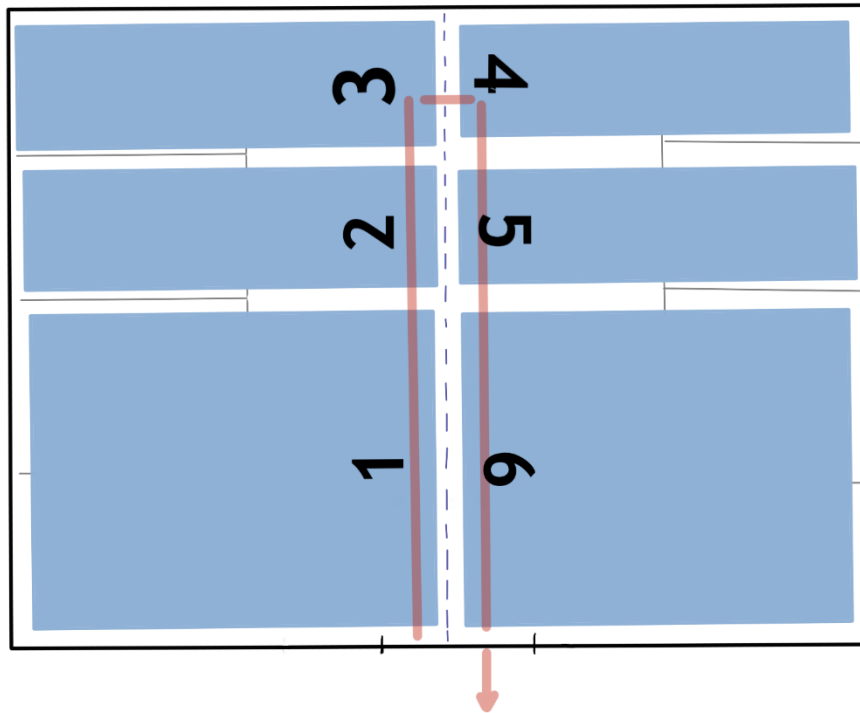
Planta da Câmara de conservação nº4 (Elaboração Própria)
